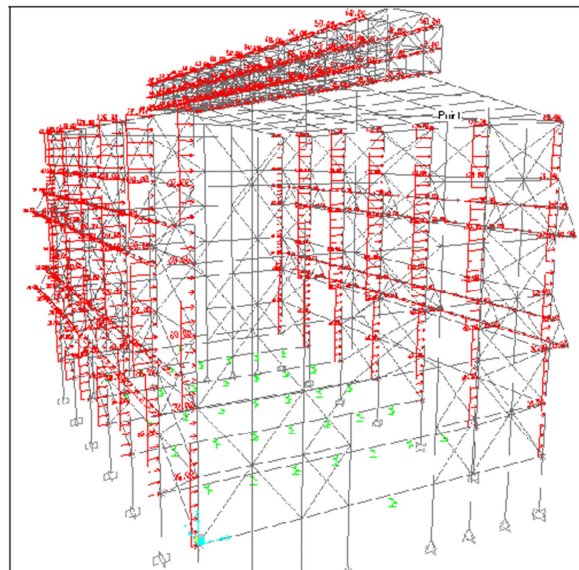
Carga de Viento en eje X (Vx) aplicada a la forma estructural.
